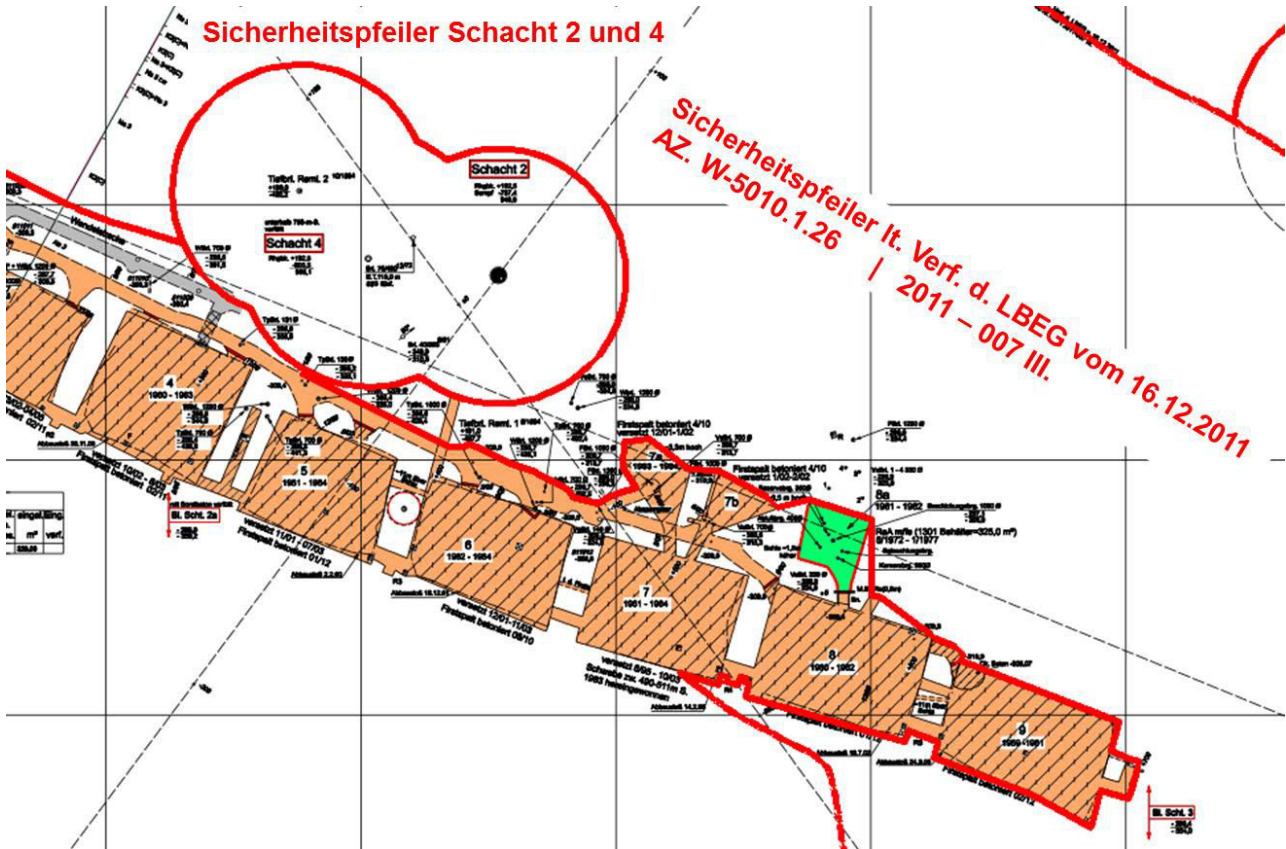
Ausschnitt aus Grundriss der 511-m-Sohle mit Lage der ELK und der Sicherheitspfeiler
